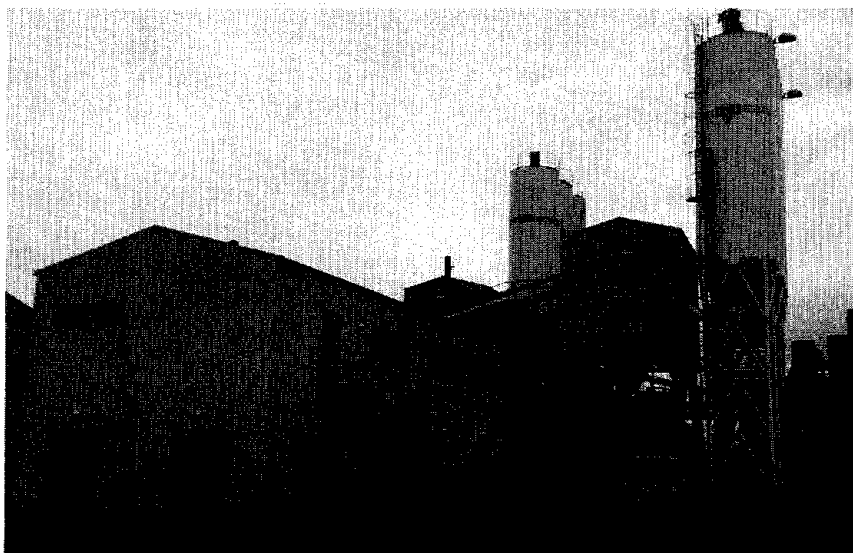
Sundlink's betongfabriker i Malmö norra hamn.
